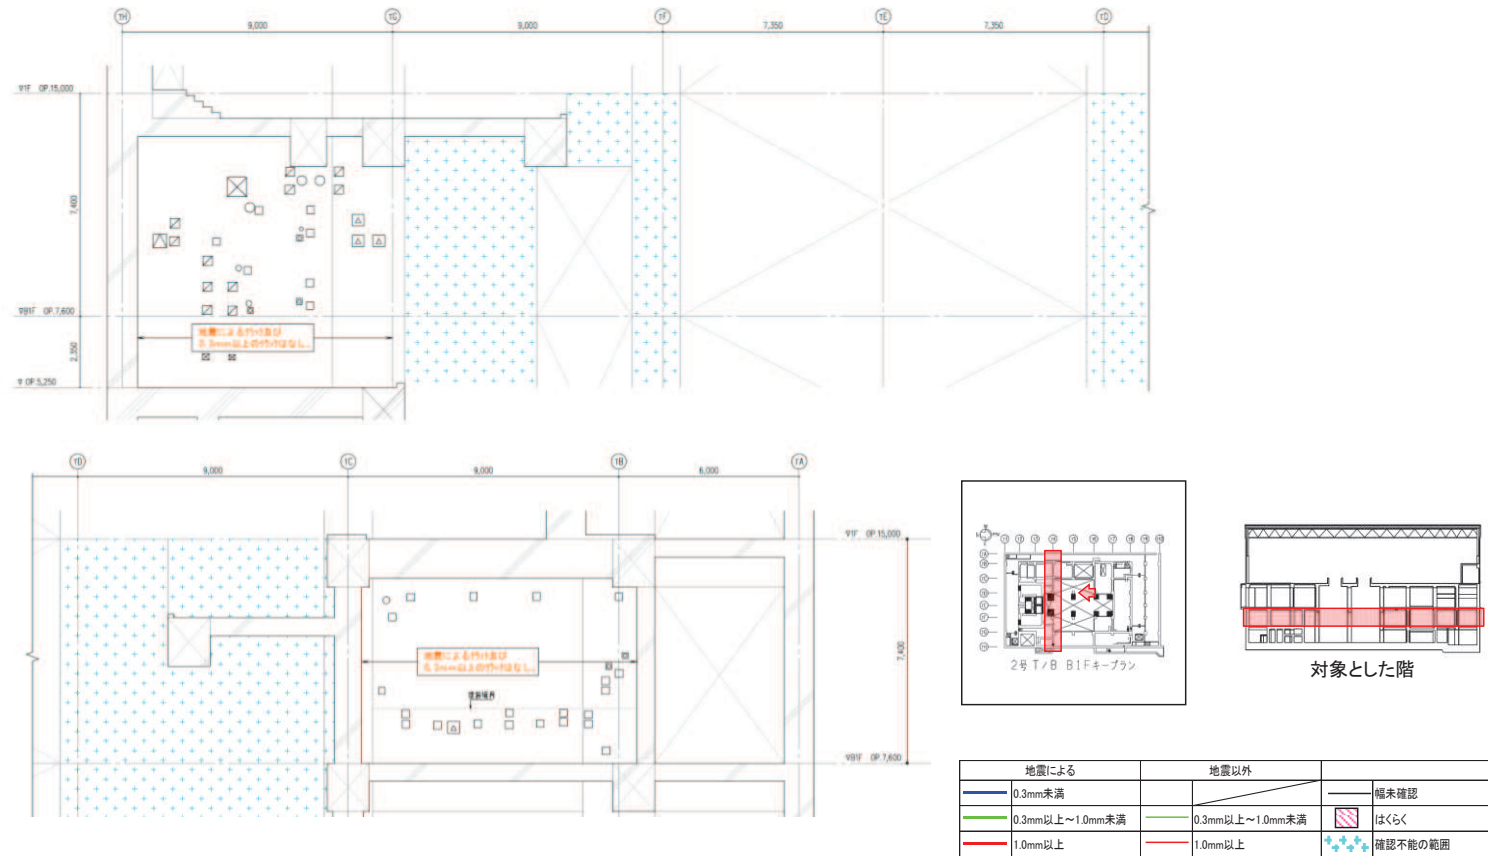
タービン建屋のひび割れ分布 耐震壁 (20) 地下 1 階 T4 通り
